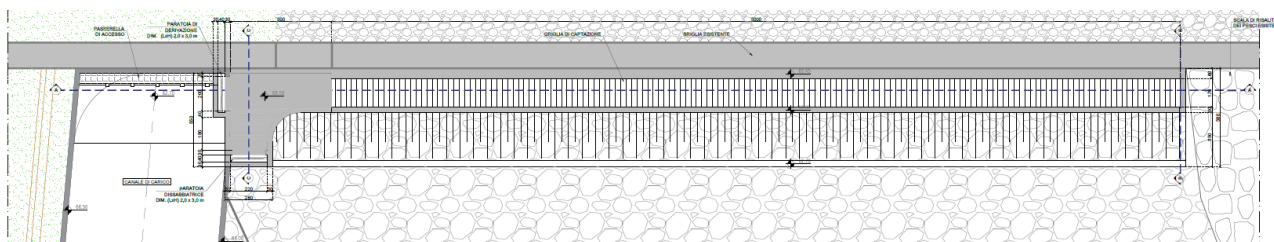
Pianta dell'opera di presa in progetto (elaborato ELG202)
